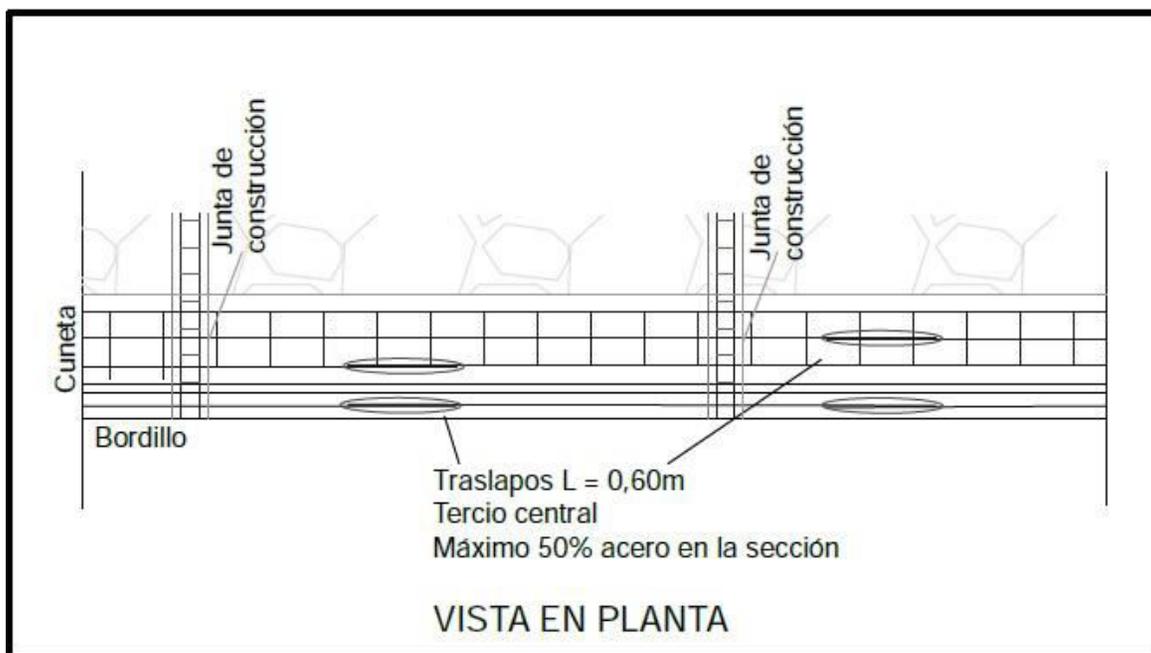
Junta Transversal de la construcción de la Berma – cuneta.
